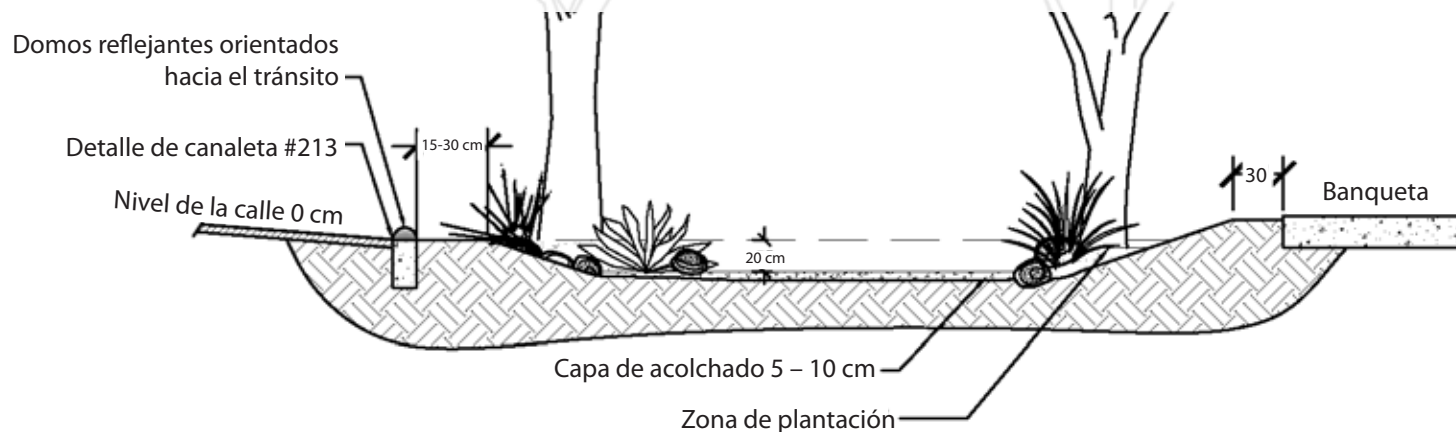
Sección D. Muestra de la reducción del ancho de una calle con canaletas al ras y zona deprimida de bioretención. Para ver el plan, vaya al Apéndice.
